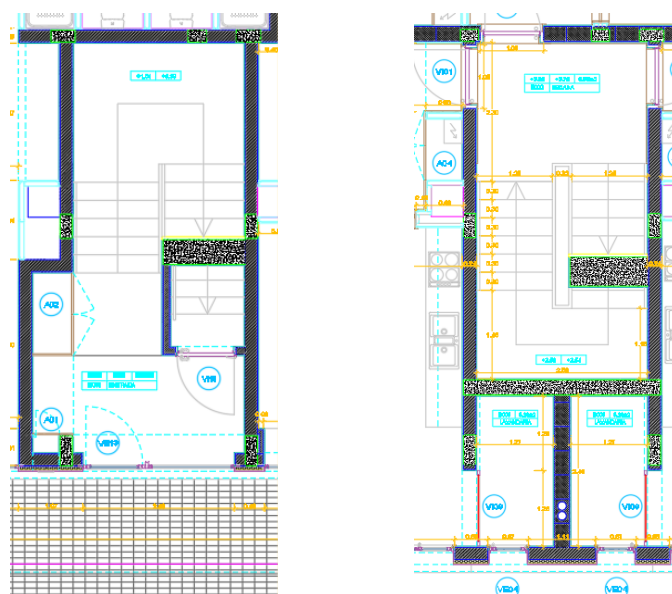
Caixa de escadas: planta do rés do chão e planta do piso 1
